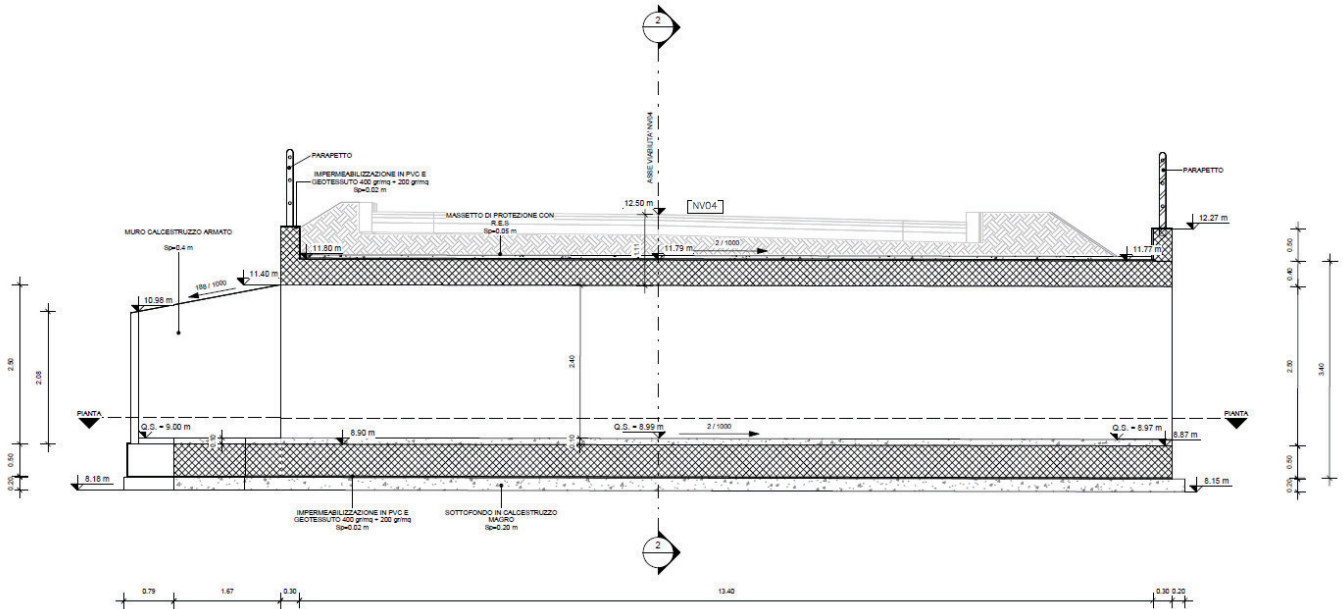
IN14 tombino stradale scatolare – sezione longitudinale
